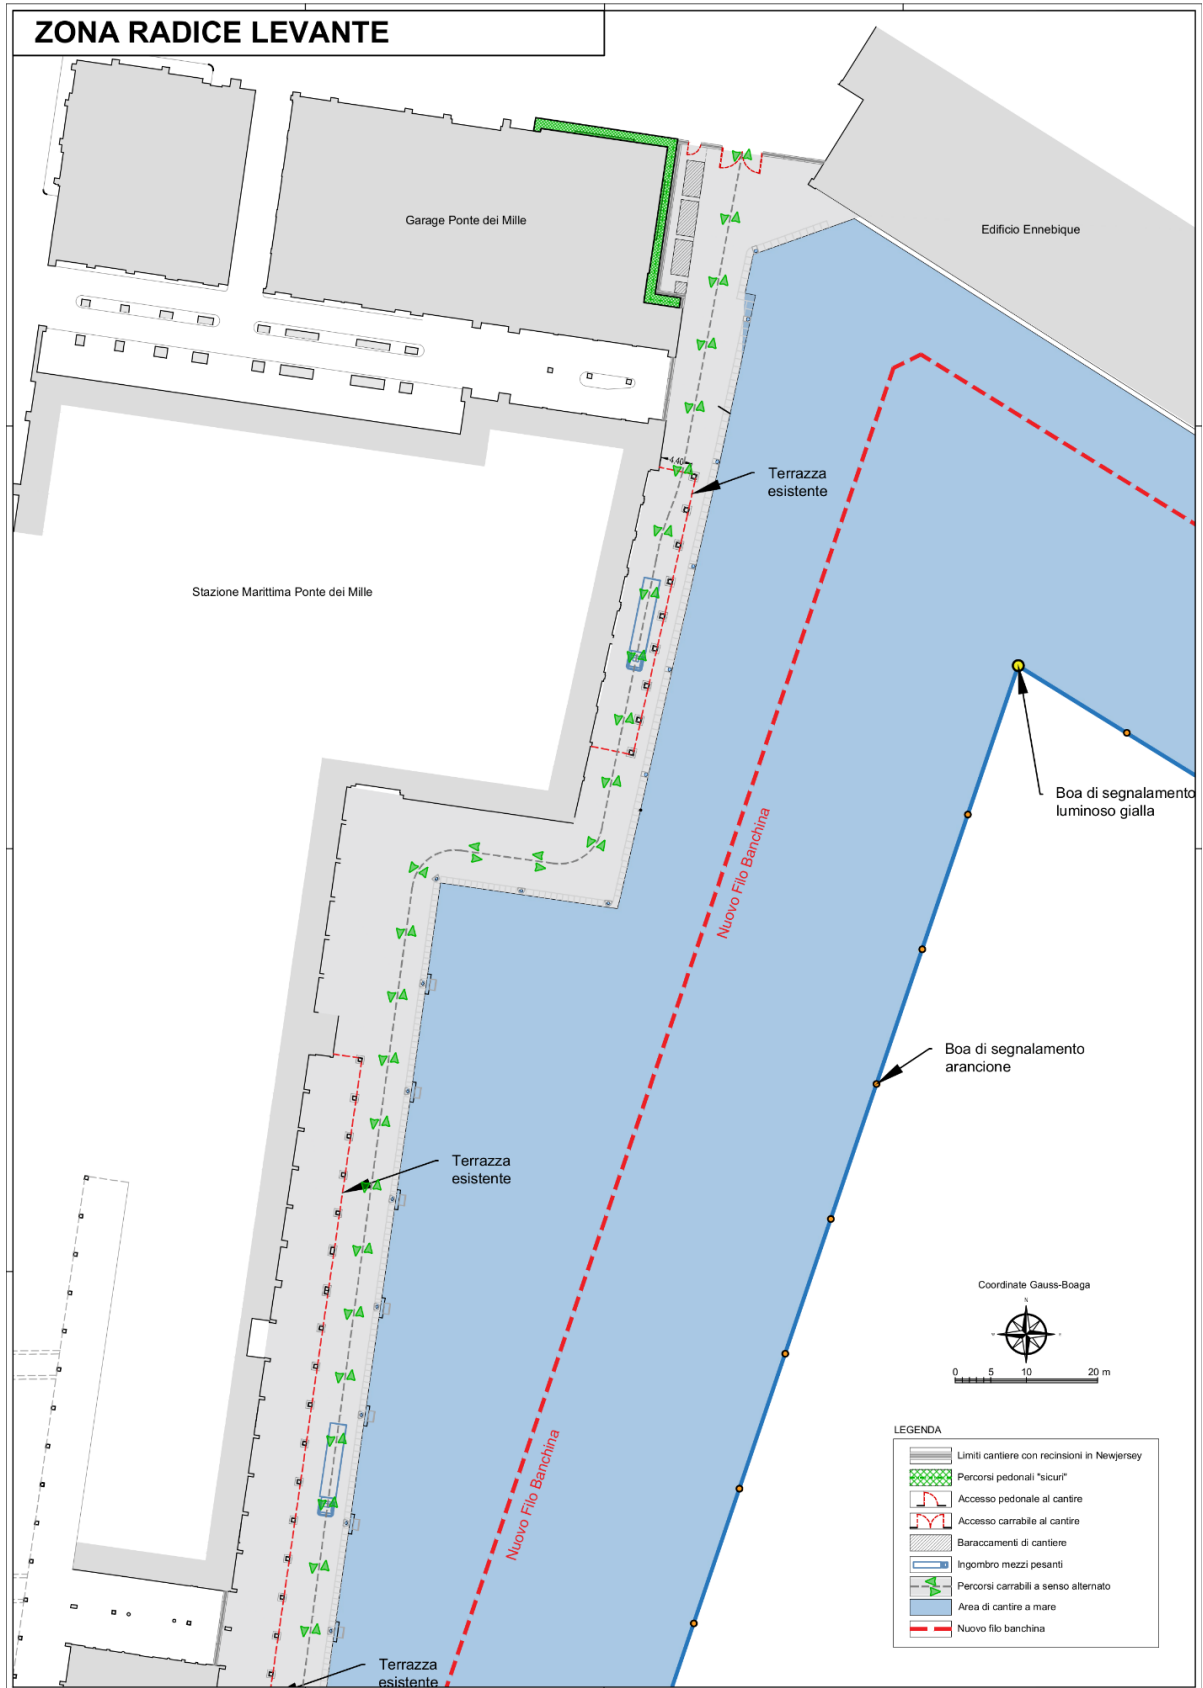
Dettaglio area radice levante Pontile- Planimetria del layout generale di cantiere
